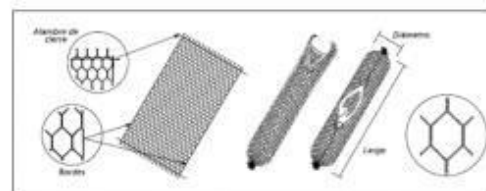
Gavión tipo saco. Fuente: (de Almeida Barros et al. 2010)
